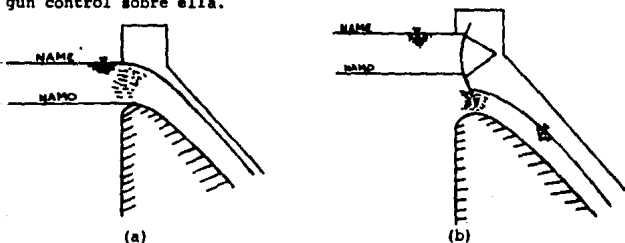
Vertedor de descarga libre (a) y des - carga controlada (b)
